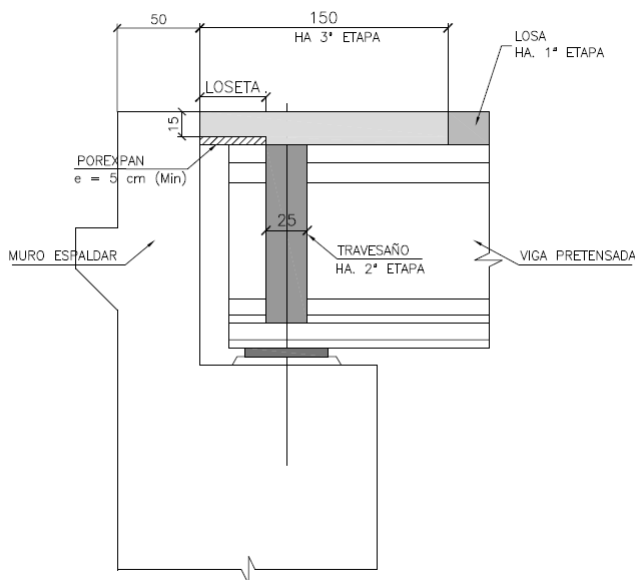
Puente Semi-Integral: Conexión mediante loseta entre el tablero y el muro espaldar del Estribo
